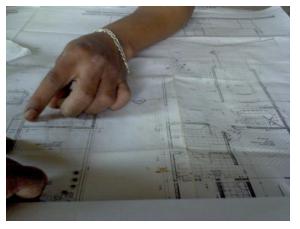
LECTURA DE PLANOS PARA LA CONSTRUCCION
